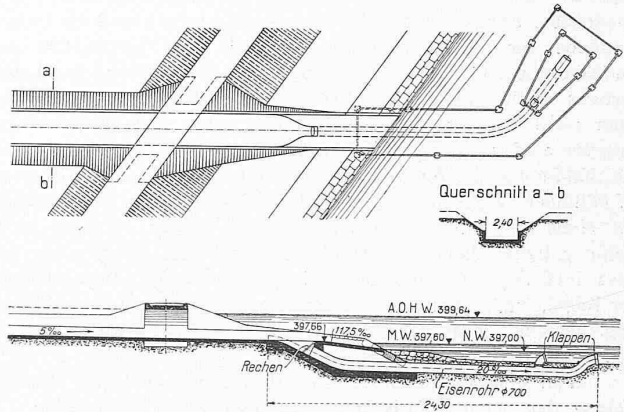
Grundriss und Schnitte des Auslaufs. — Masstab 1:500.
